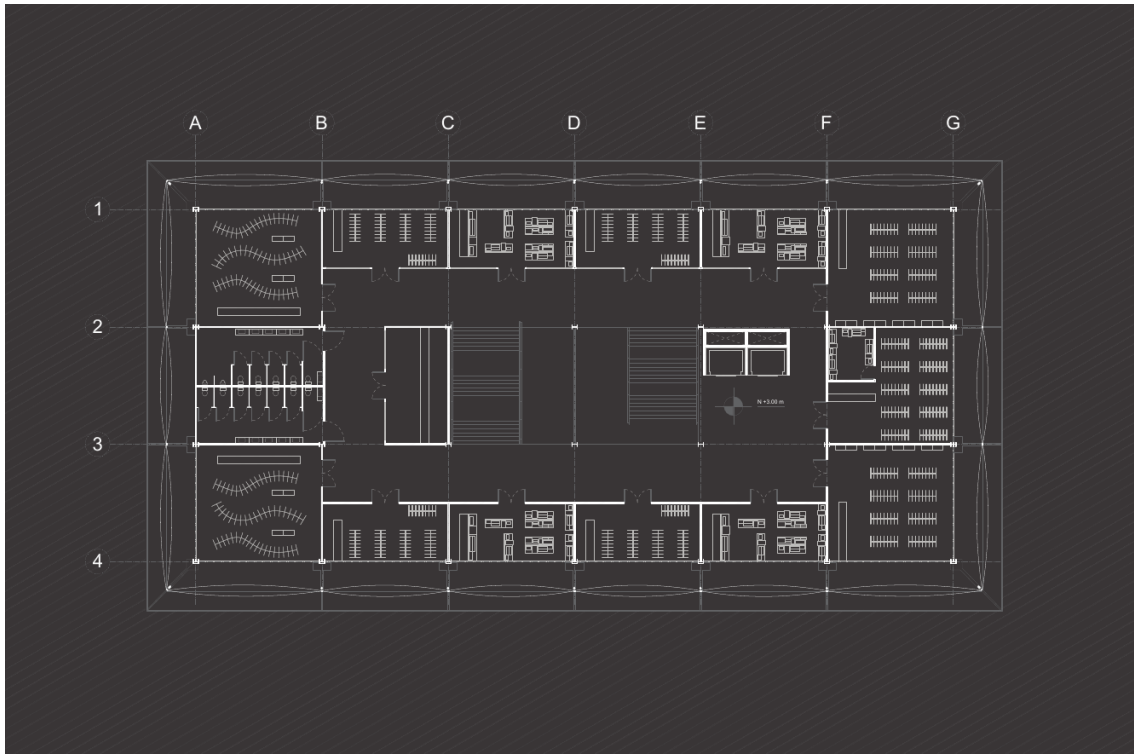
Planta nivel +3.00, Fuente: Elaboración propia
